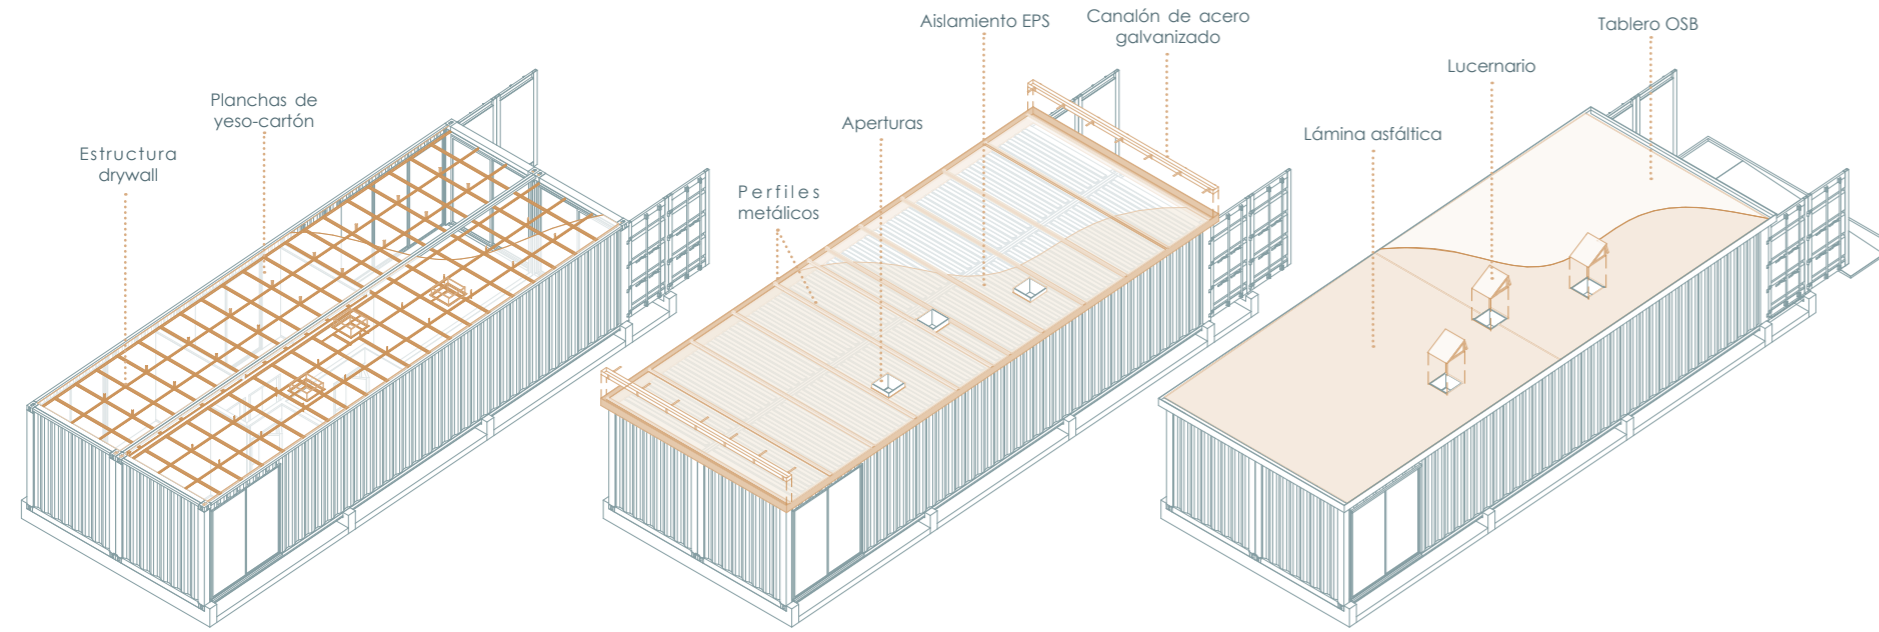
Proceso constructivo vivienda tipo 2. Fuente: Autores, 2023
